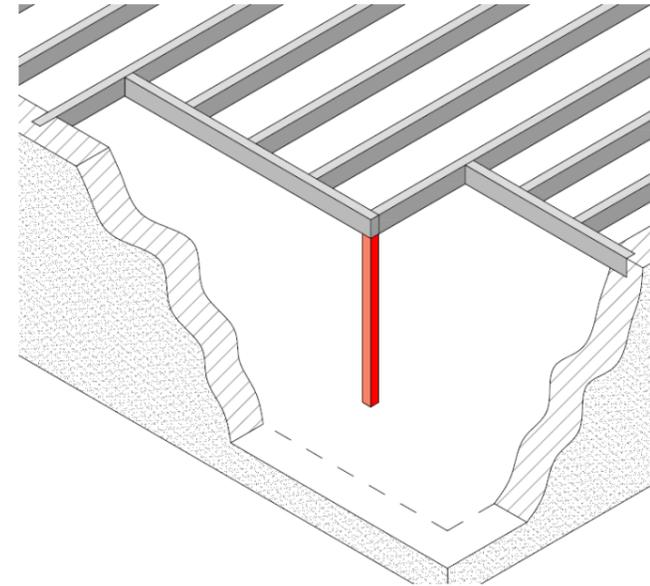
Colocación de pilar en hueco de escalera. 2014. Fuente: elaboración propia
